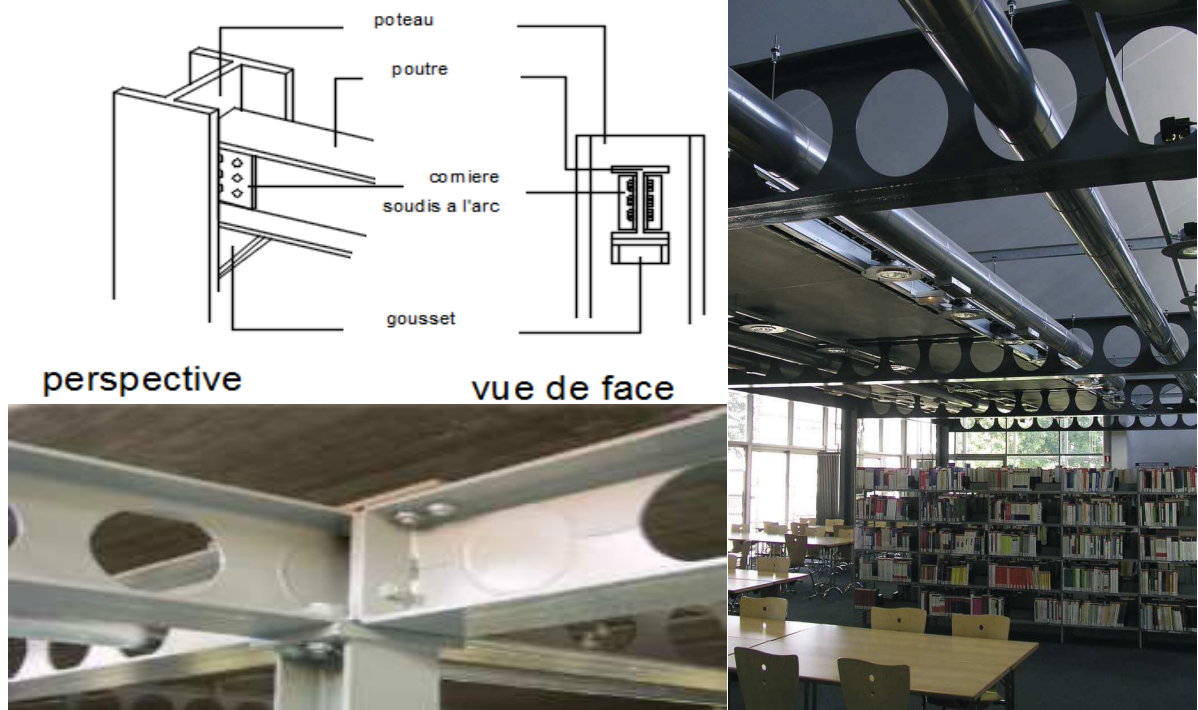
assemblage poteaux poutre source: <http://www.batirama.com>
